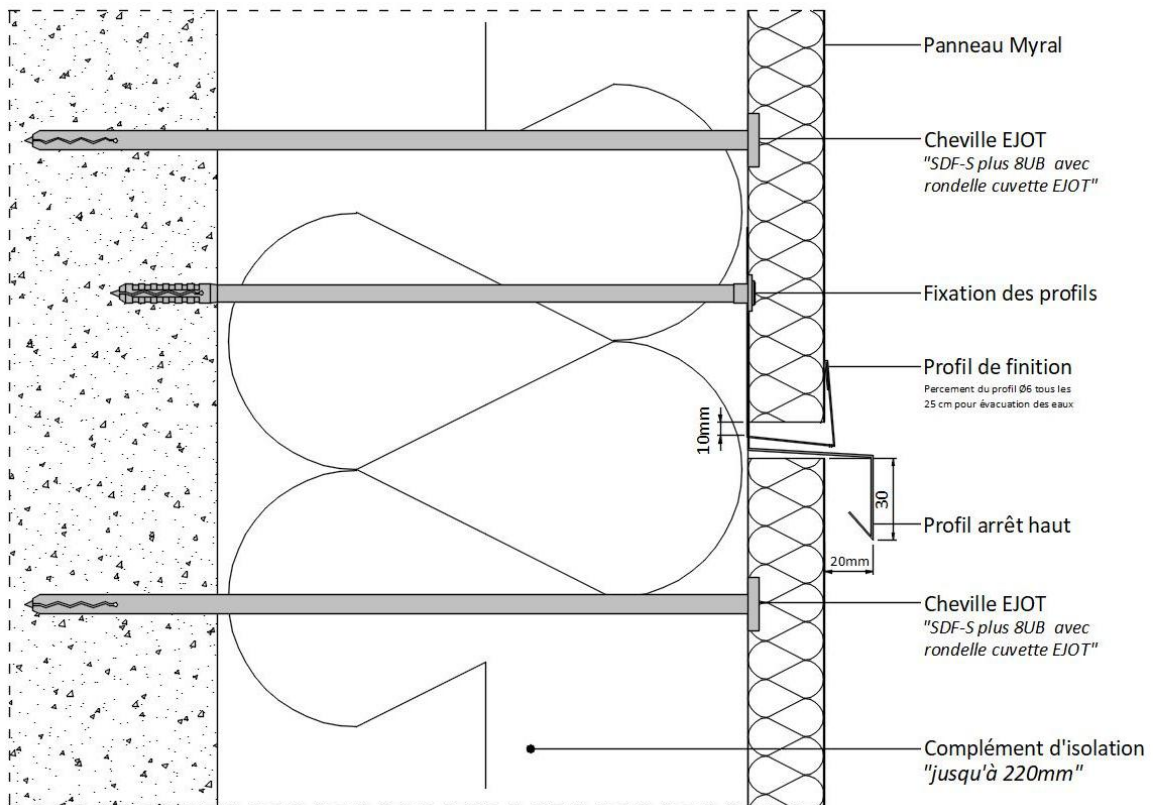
Fractionnement du vêtage au droit de chaque plancher sur béton
